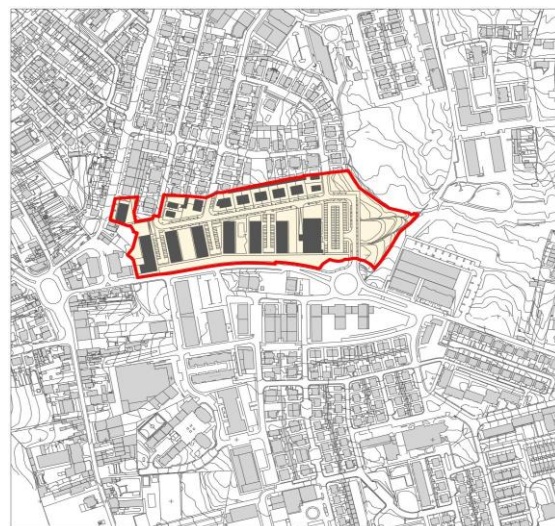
Planta do Alvará de Loteamento n.º 22/10
